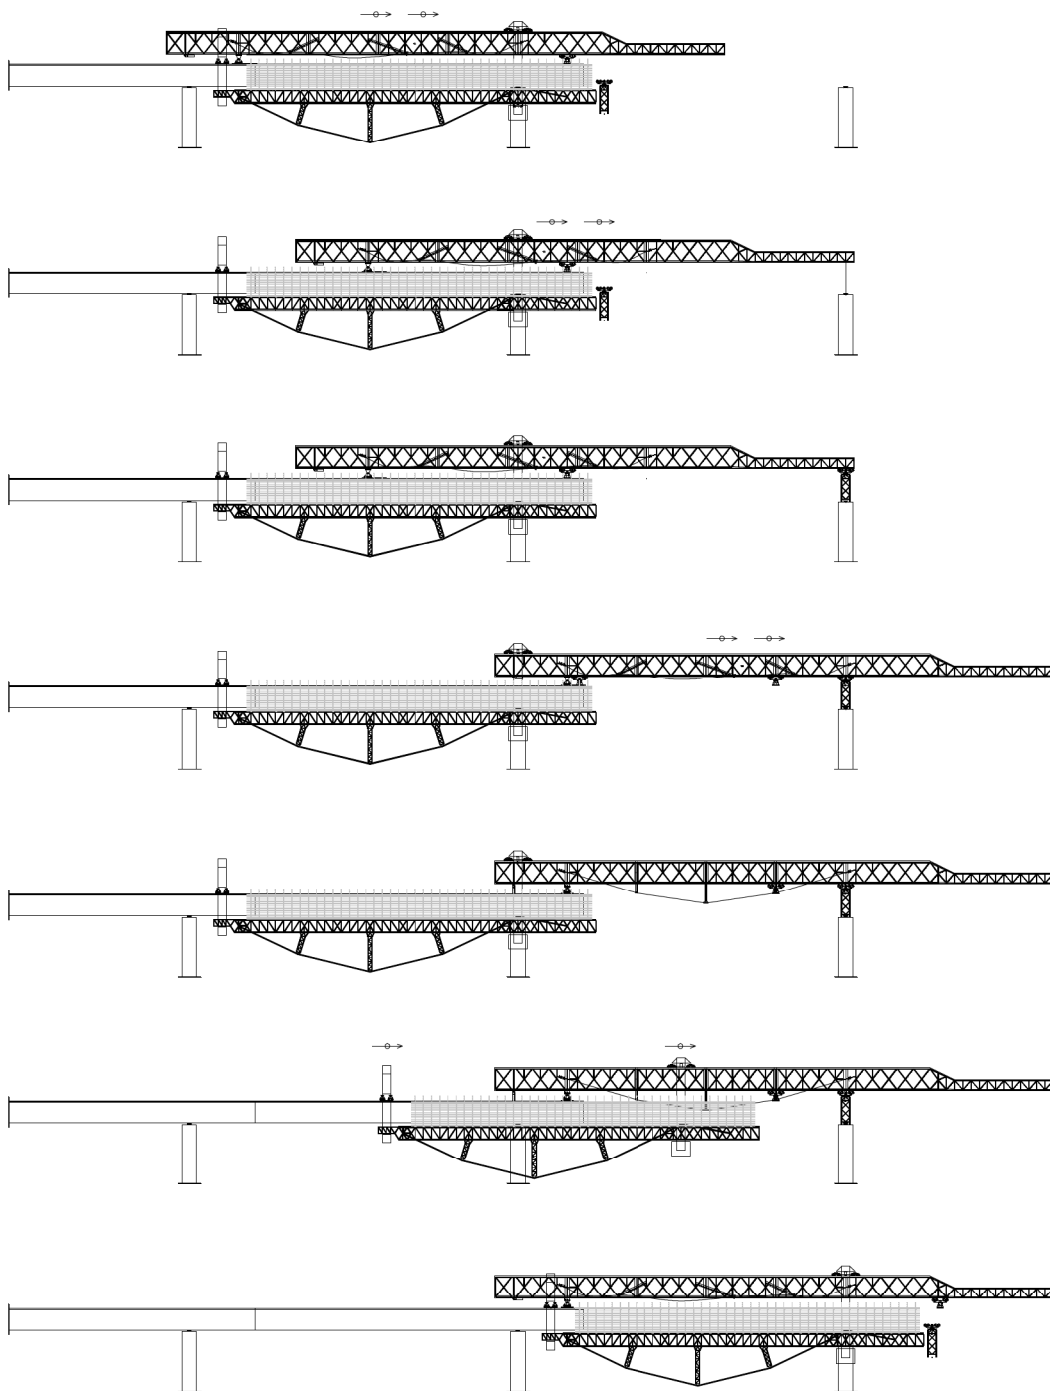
Lanzamiento de autocimbra híbrida con OPS
